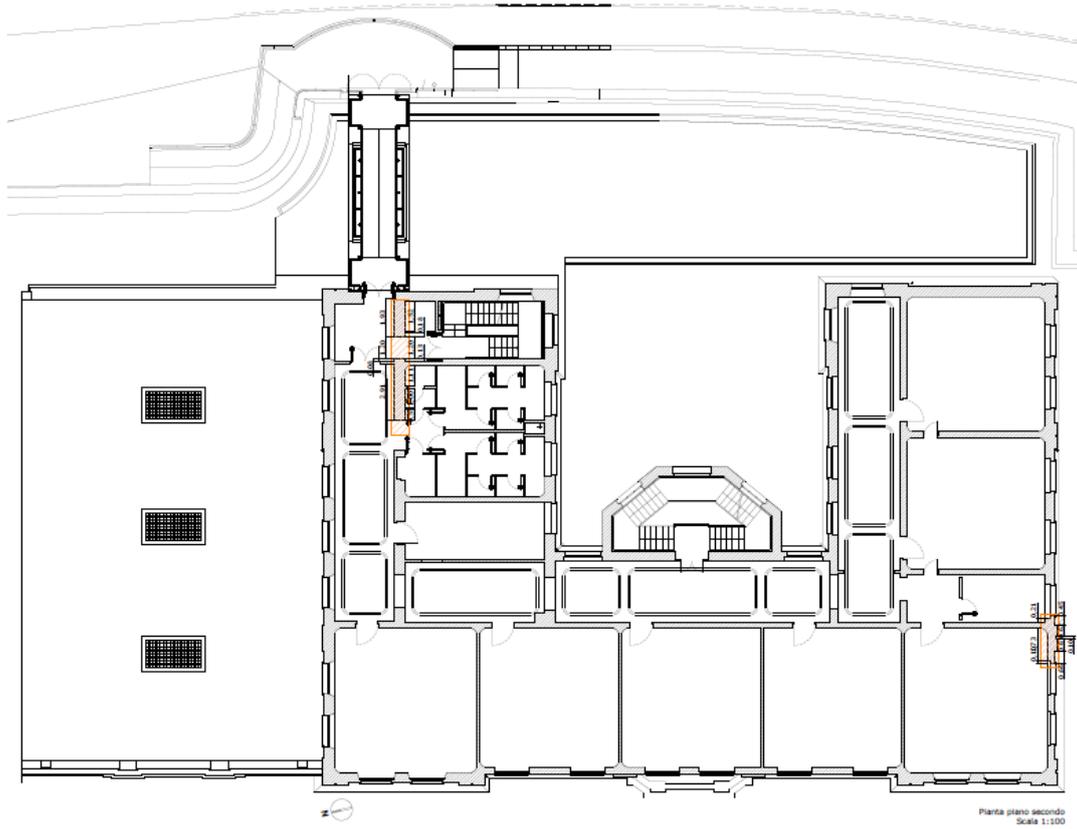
Pianta piano Secondo con indicazione delle zone di intervento
